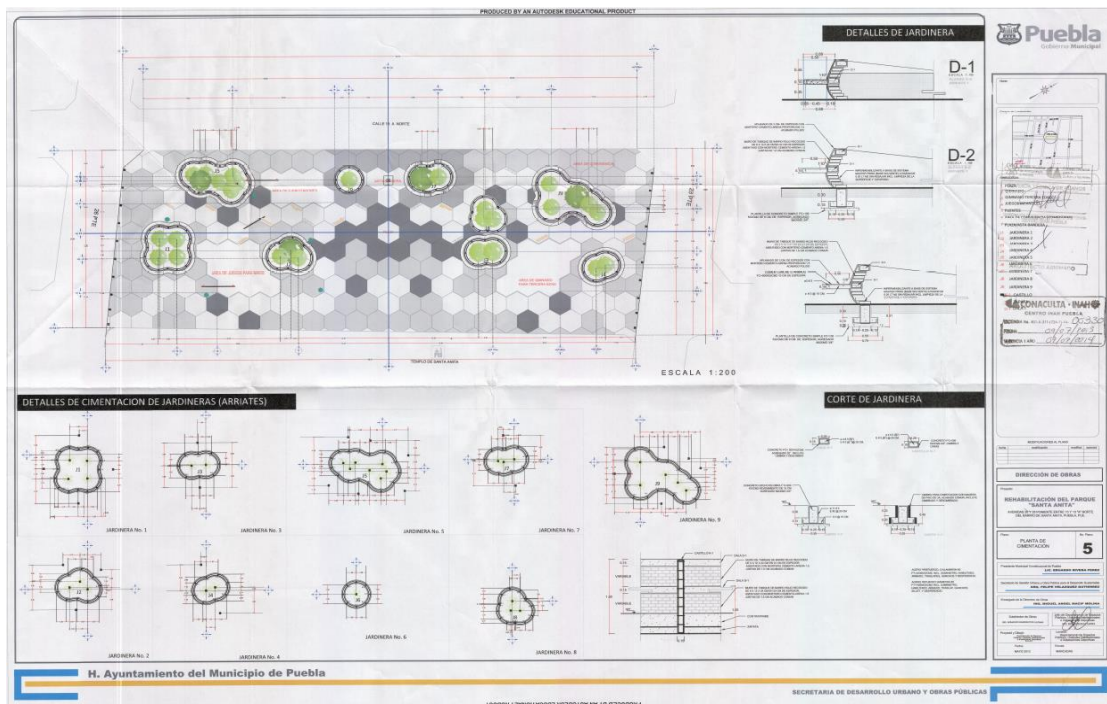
Plano 5. Diseño y detalles constructivos de las Jardineras. Fuente: Dirección de Obras Públicas, H. Ayuntamiento de Puebla
